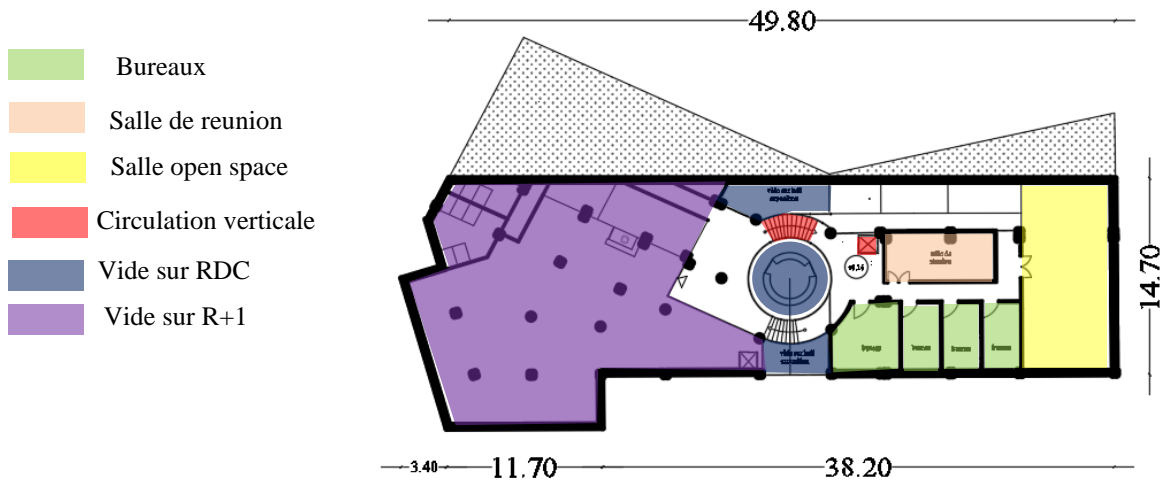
Plan R+2 Affaire. (Source : Auteur)
